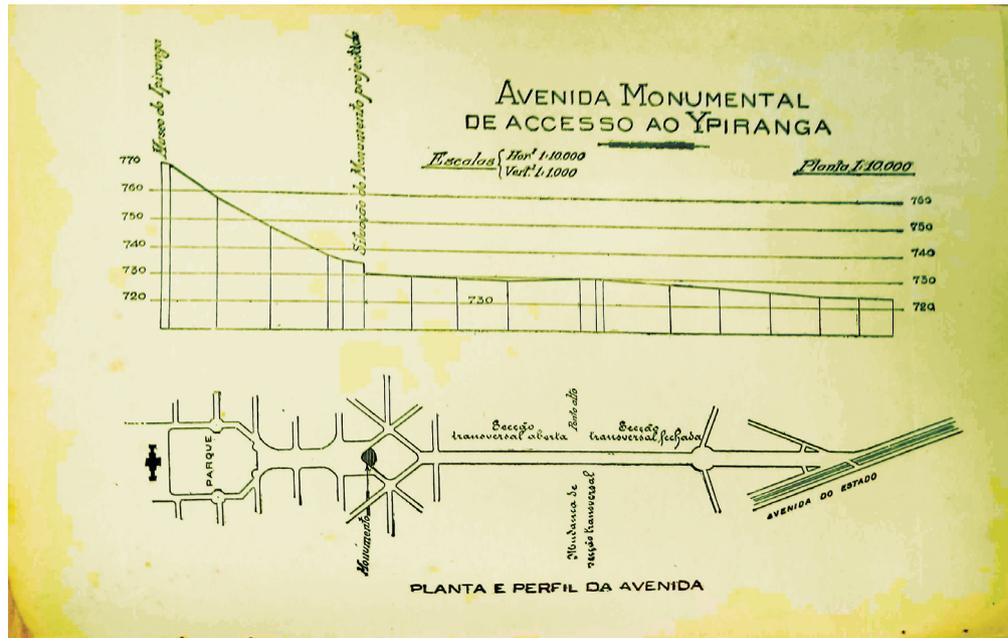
Perfil longitudinal e planta da avenida d. Pedro I, [191-?]. Secretaria do Interior, 1919.
